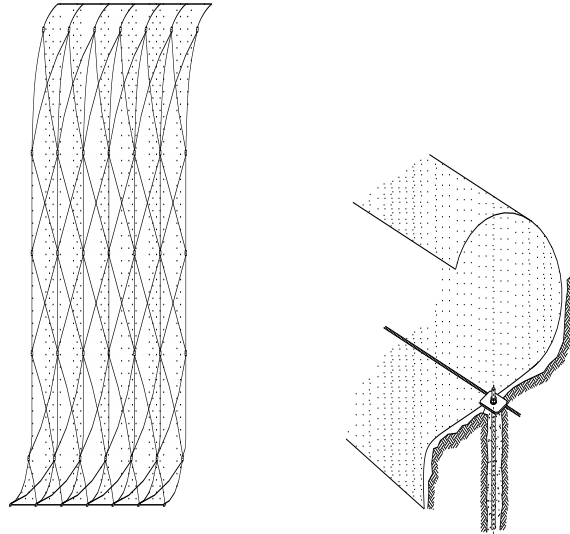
Colocación de cables diagonales de refuerzo y solape en coronación
